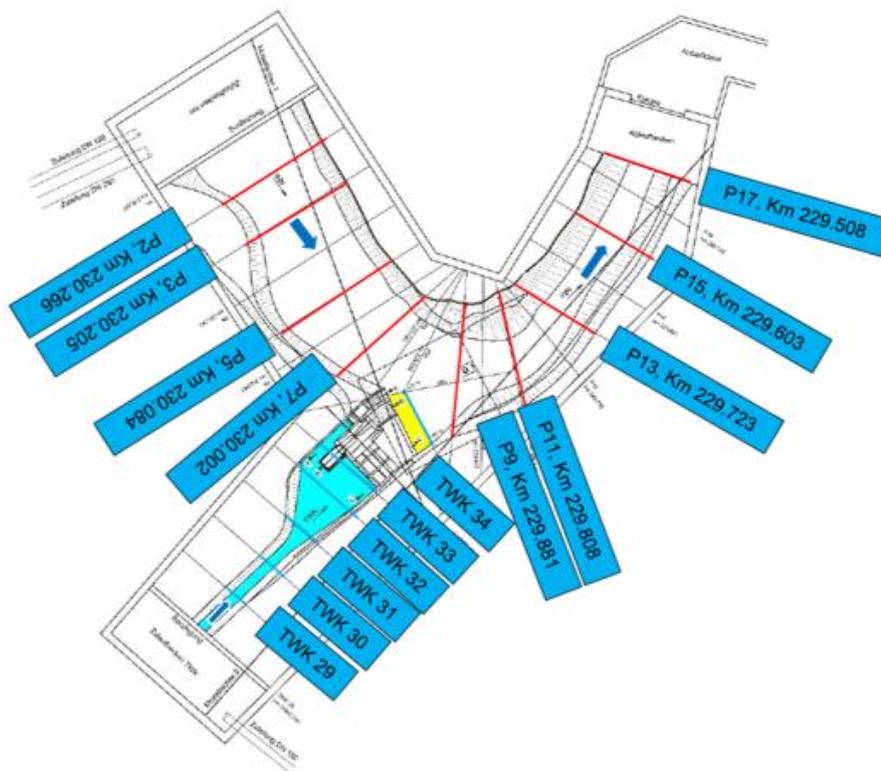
Modelllageplan Kirchbichl 2 [1]
